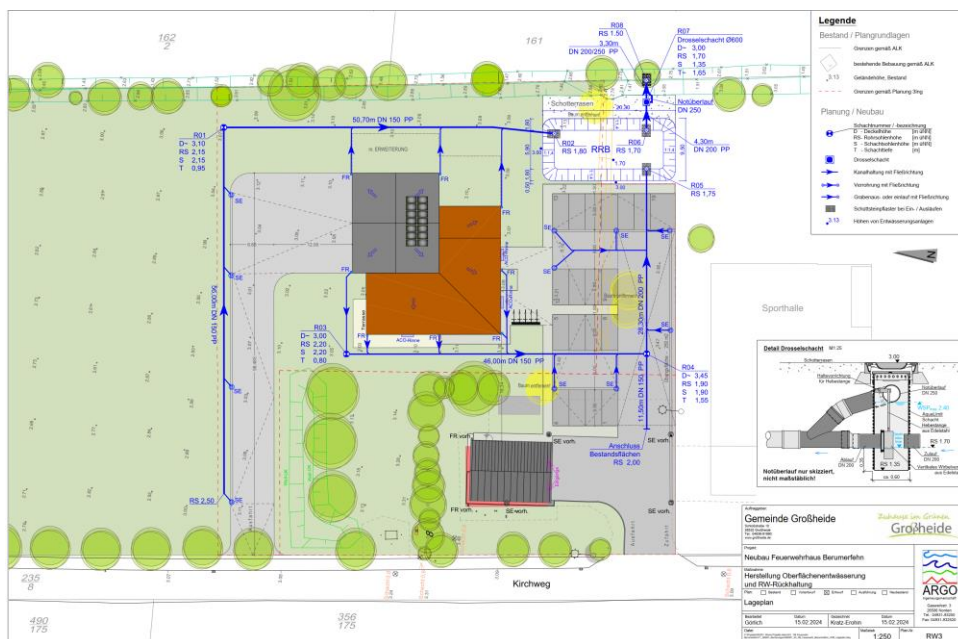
Darstellung der Entwässerung des Plangebietes
